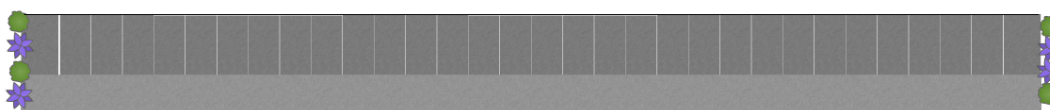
Rozmístění navrhovaných parkovacích míst
